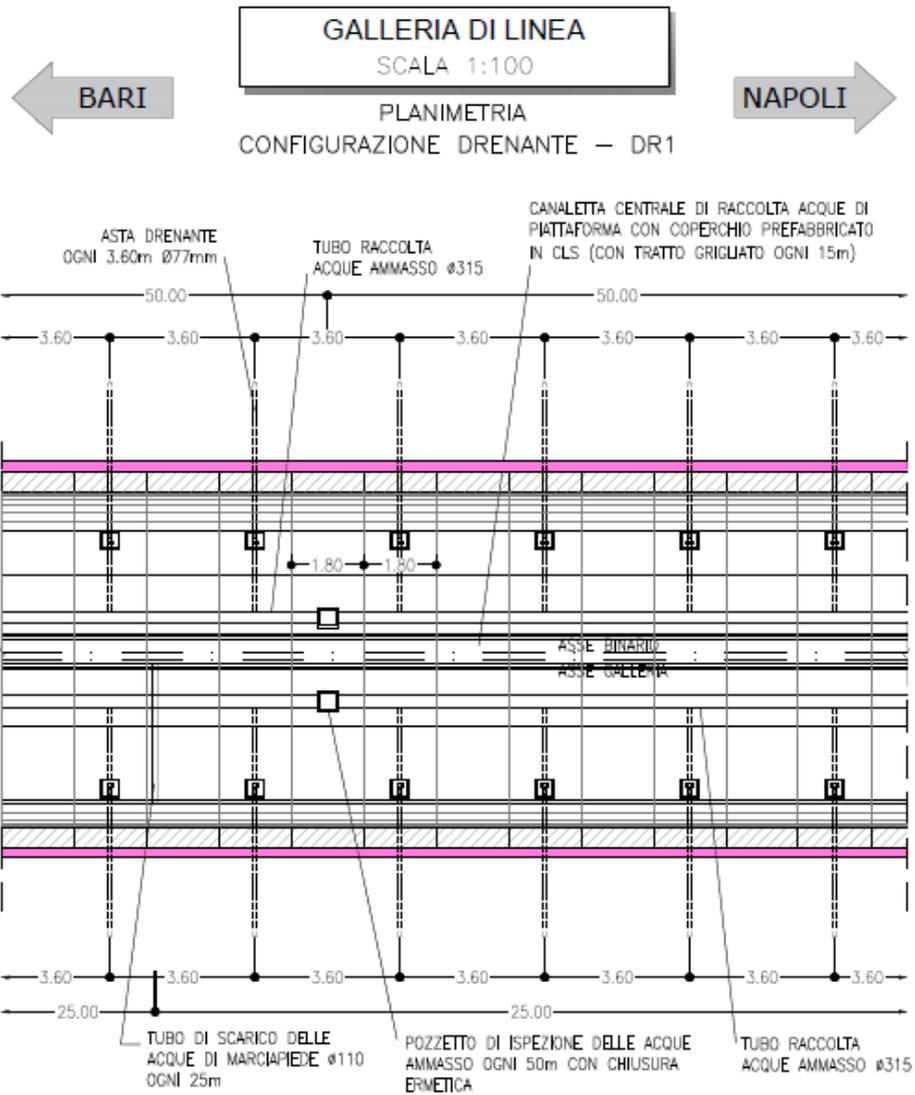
Sistema di drenaggio acque d'ammasso - DR1 (planimetria)
